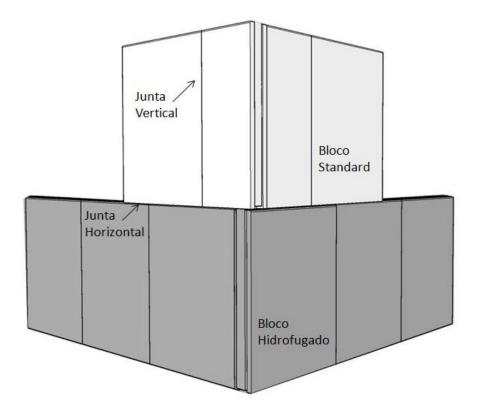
Detalhe do encontro entre paredes com amarração alternada
